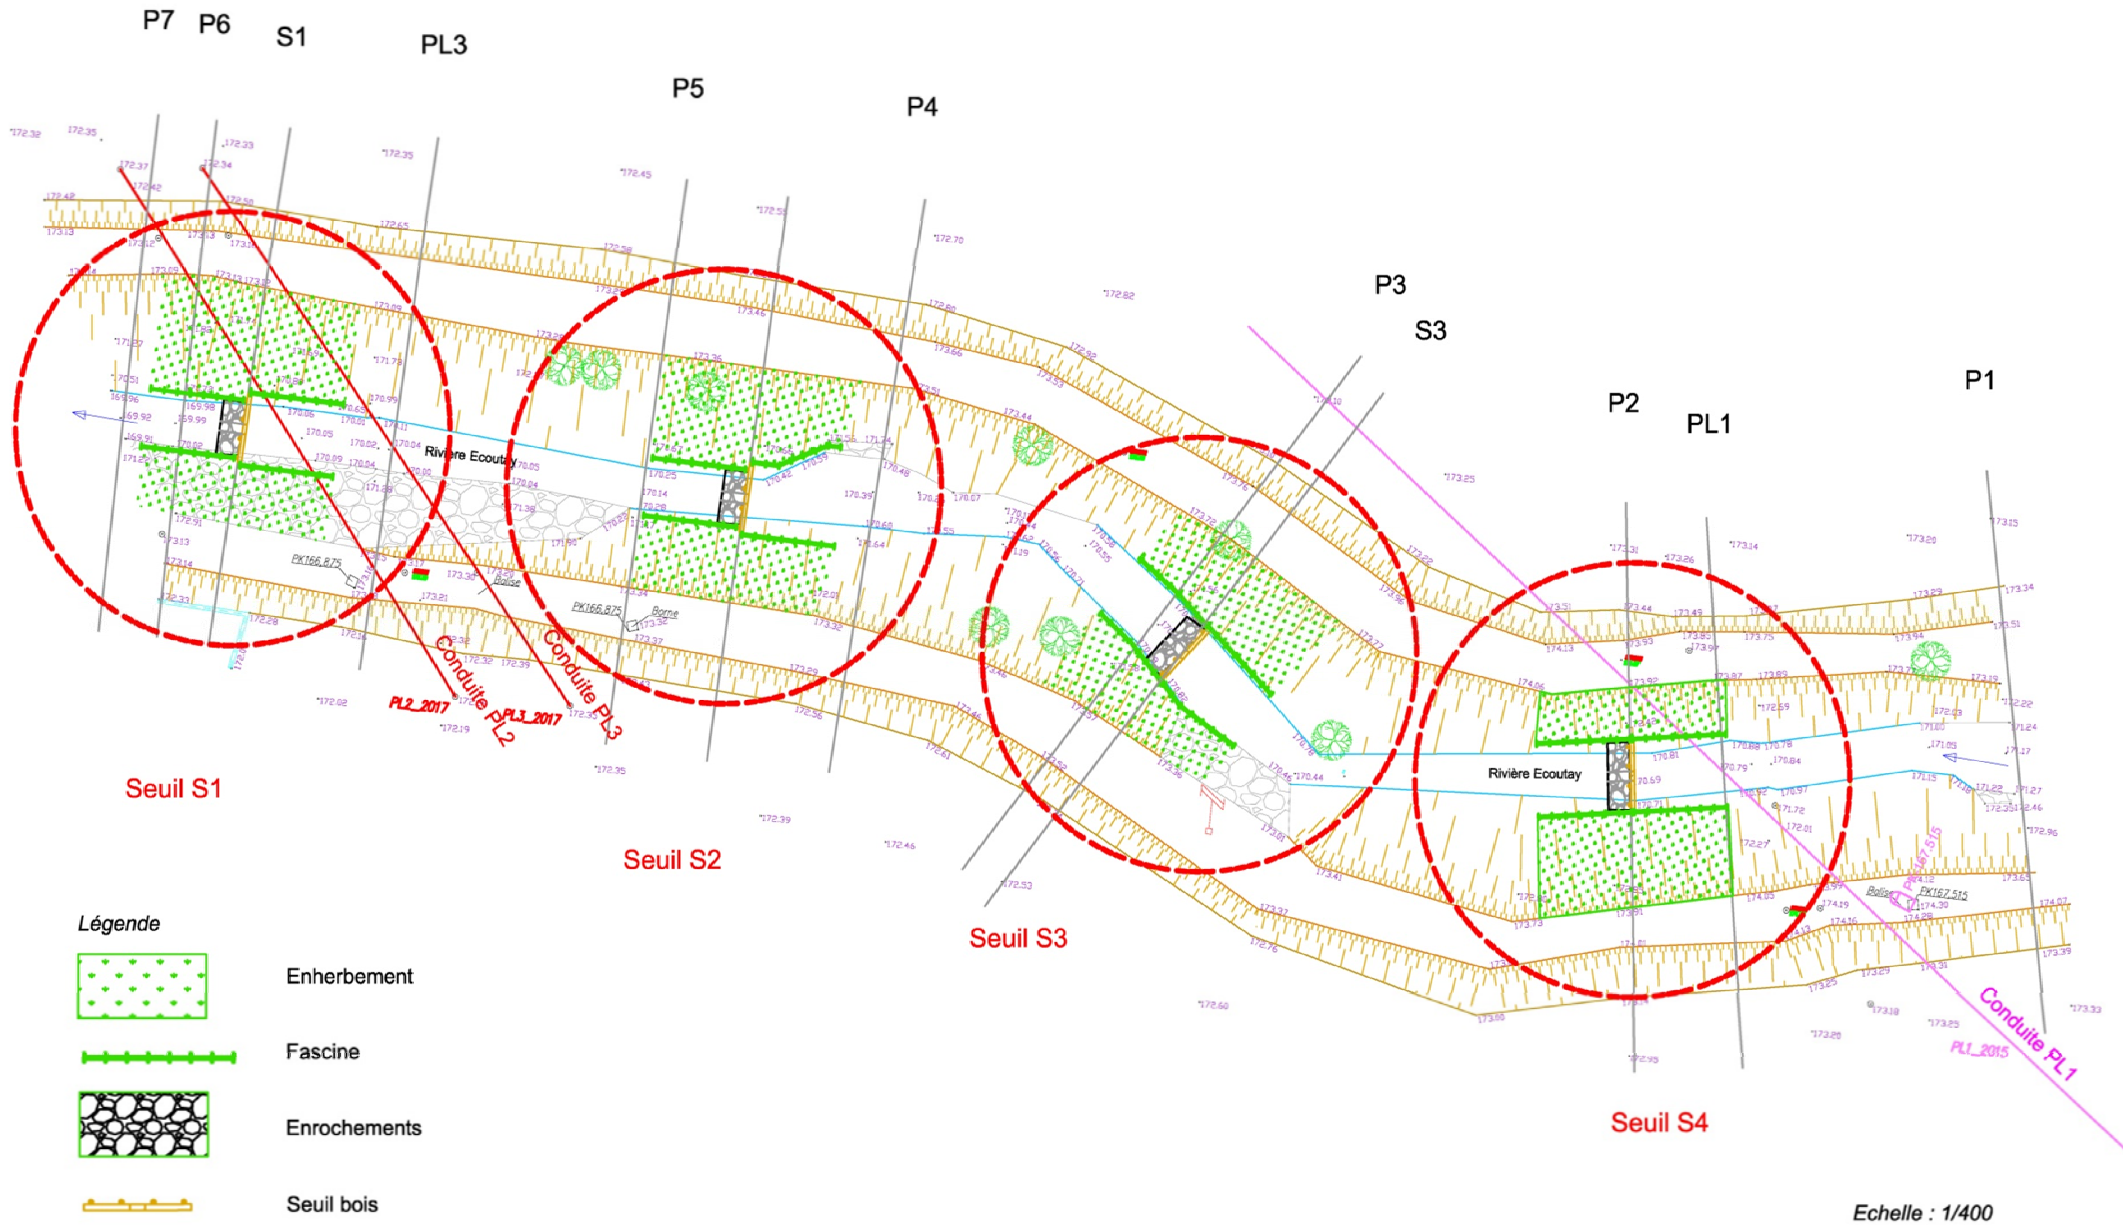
Plan et coupes - Intervention Ecoutay (26)
